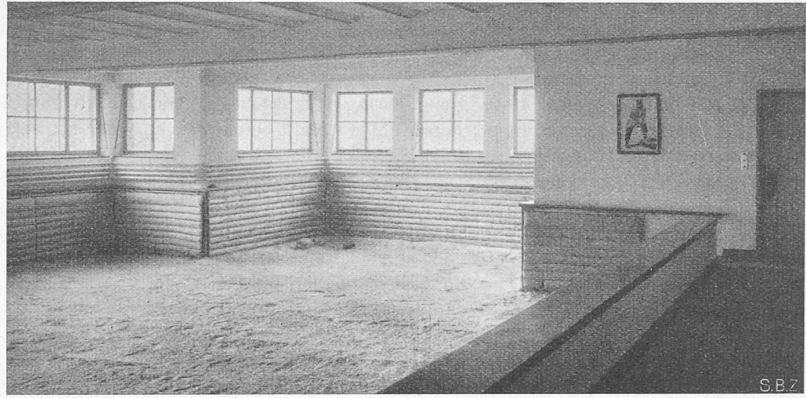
Nationalturn-Halle im Untergeschoss der Turnhallenanlage Emmersberg, Schaffhausen.
